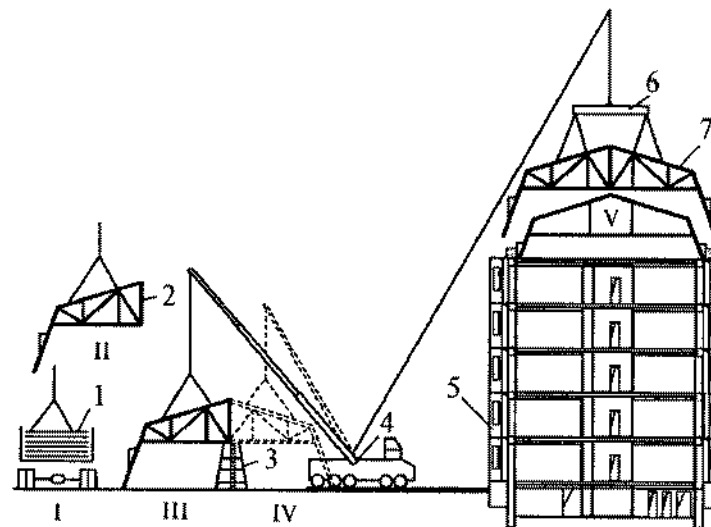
Схема монтажа объемных блоков мансардных этажей:
